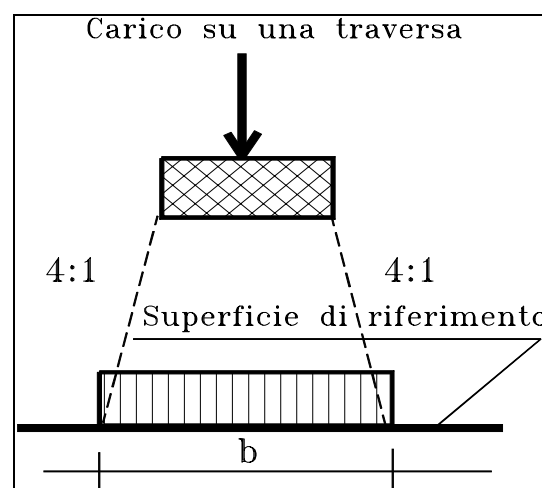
Distribuzione longitudinale dei carichi attraverso il ballast.
